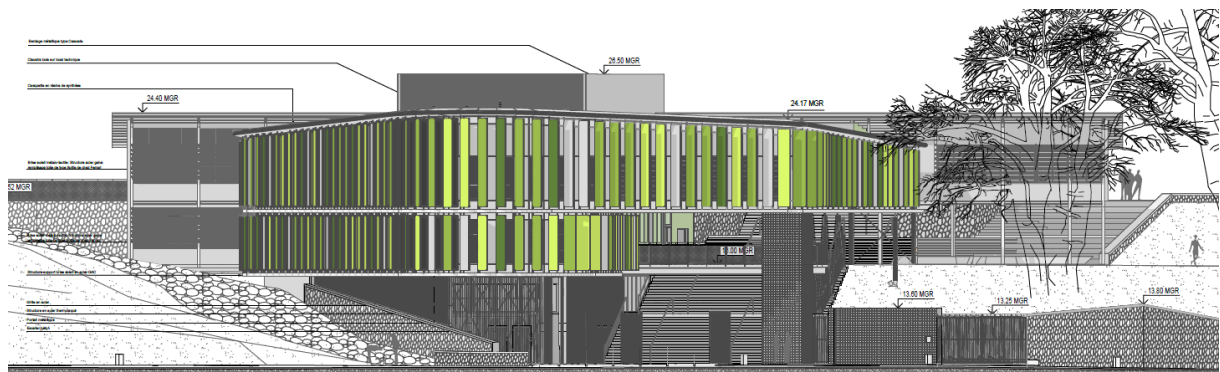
31: Illustration des protections solaires des façades du bâtiment A- © Antoine Perrau Architectures
